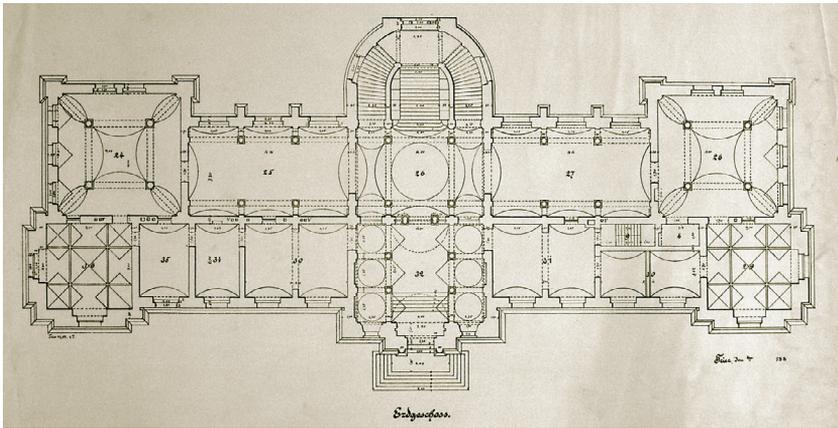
Trier, Museum. Grundriß Erdgeschoß, nach 1886.
